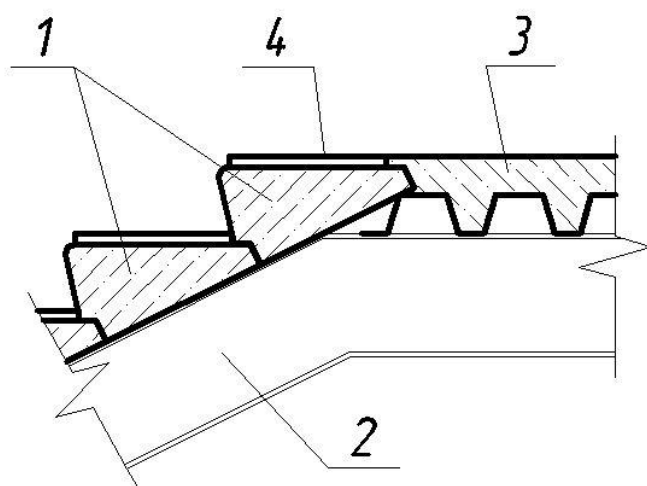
Внутренняя лестница: 1 – сборные железобетонные ступени; 2 – металлический косоур из швеллера №24; 3 – железобетонная площадка лестницы по несъемной опалубке; 4 – накладная проступь.
